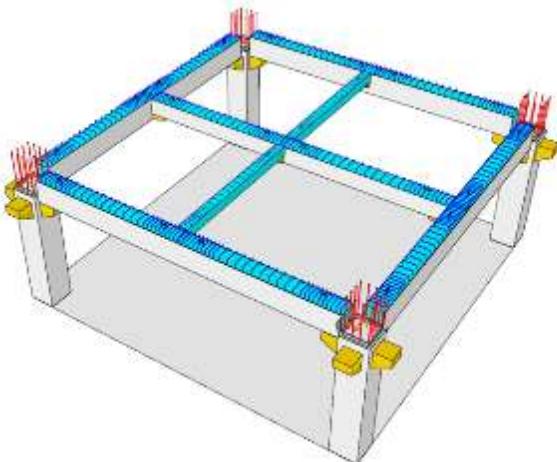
Proses Pemasangan Balok Anak Beton Pracetak Arah Memanjang
